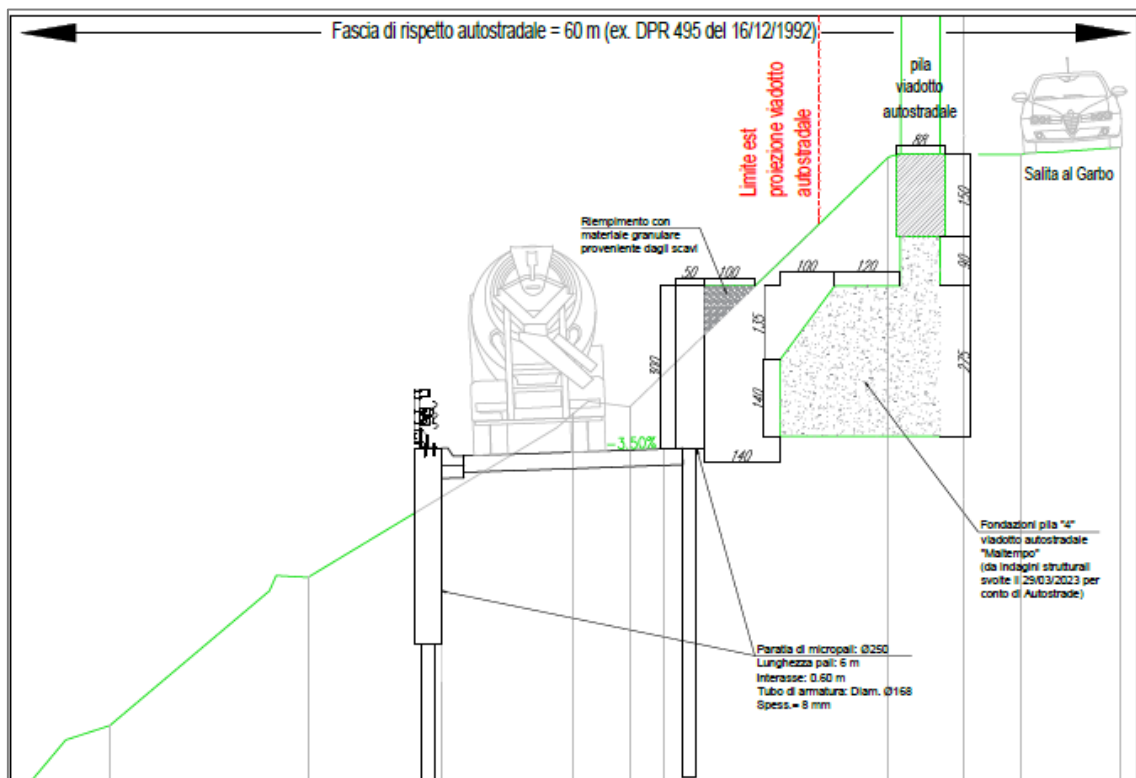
Estratto della sezione ubicata n. 7bis, in cui la rampa stradale si trova alla minima distanza dalle fondazioni della "pila 4" del viadotto autostradale "Maltempo" (rif. II151F-PD-CAN-D008_1)
